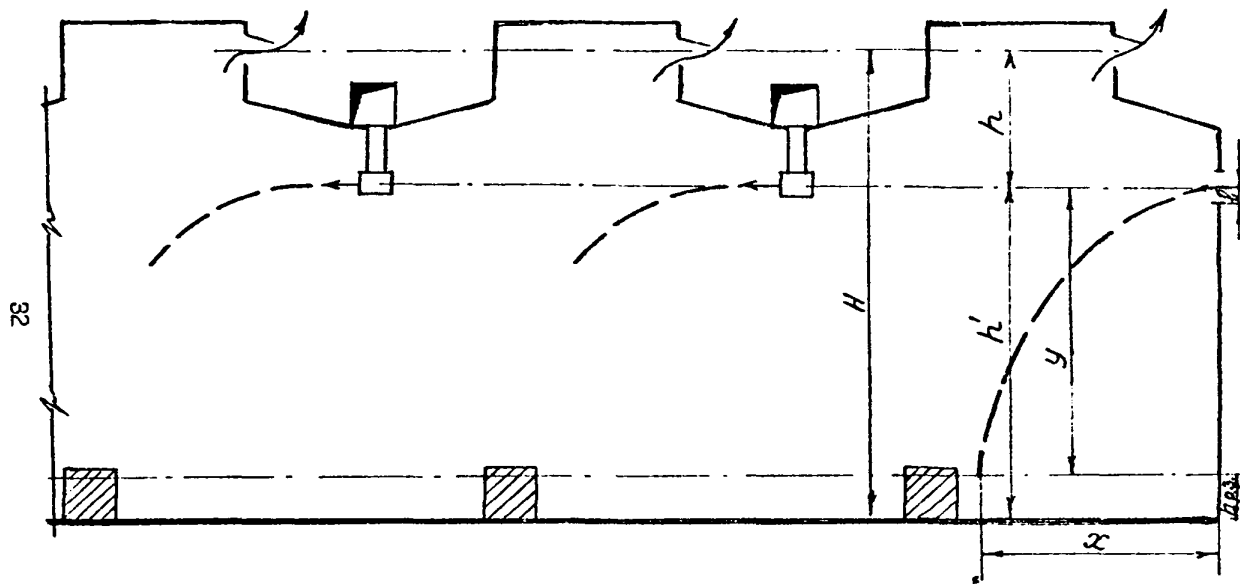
Схема смешанной общеобменной вентиляции многопролетного здания с тепловыделениями во всех пролетах
